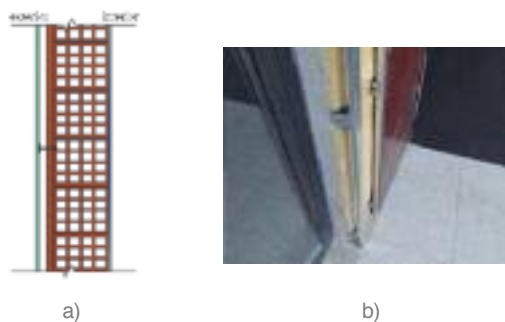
Fachada ventilada: a) desenho esquemático; b) situação real com aplicação de PUR.
